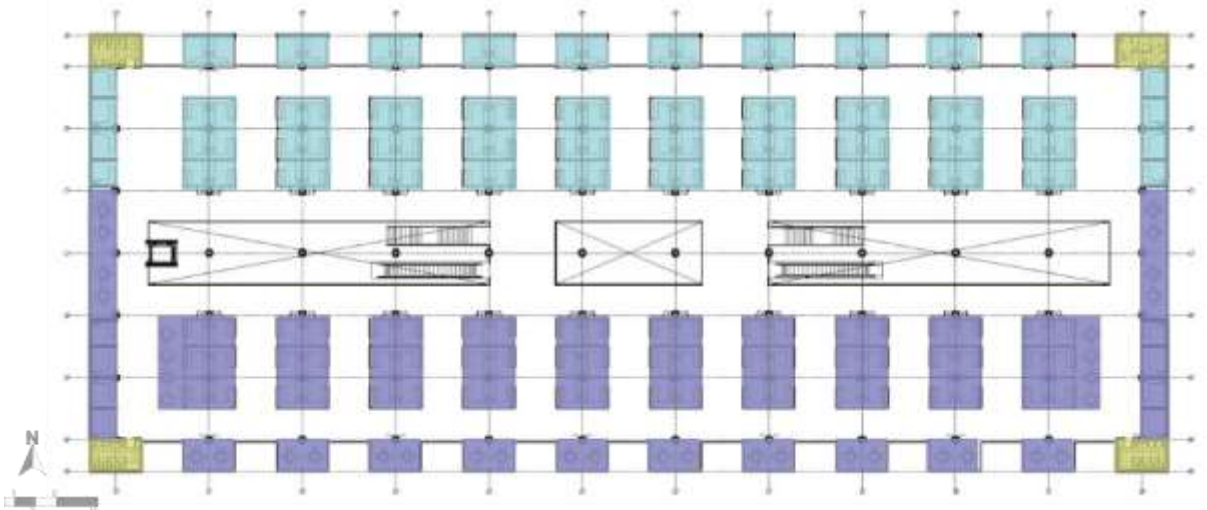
Zonificación Planta Alta, Fuente: Iglesias Pratt (2011), Elaboración Propia.
